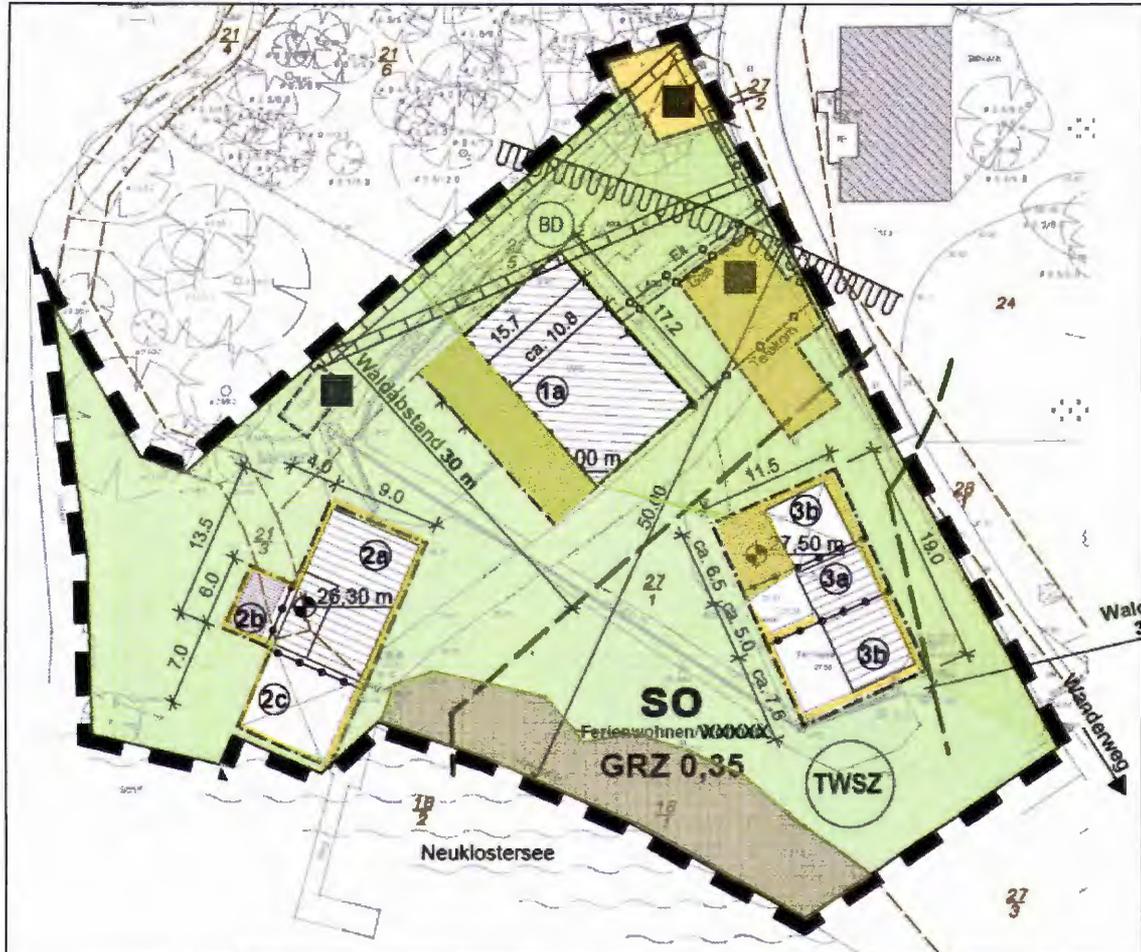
Vorhaben im Zusammenhang mit Eingriffen in Lebensräume. Gelbe Flächen: Anbauten im Bereich der Gebäude und Anlage von Stellplätzen, Grün=PGZ, Olivgrün=Schilf. Kartengrundlage: B.-Plan Entwurf bab Wismar.
